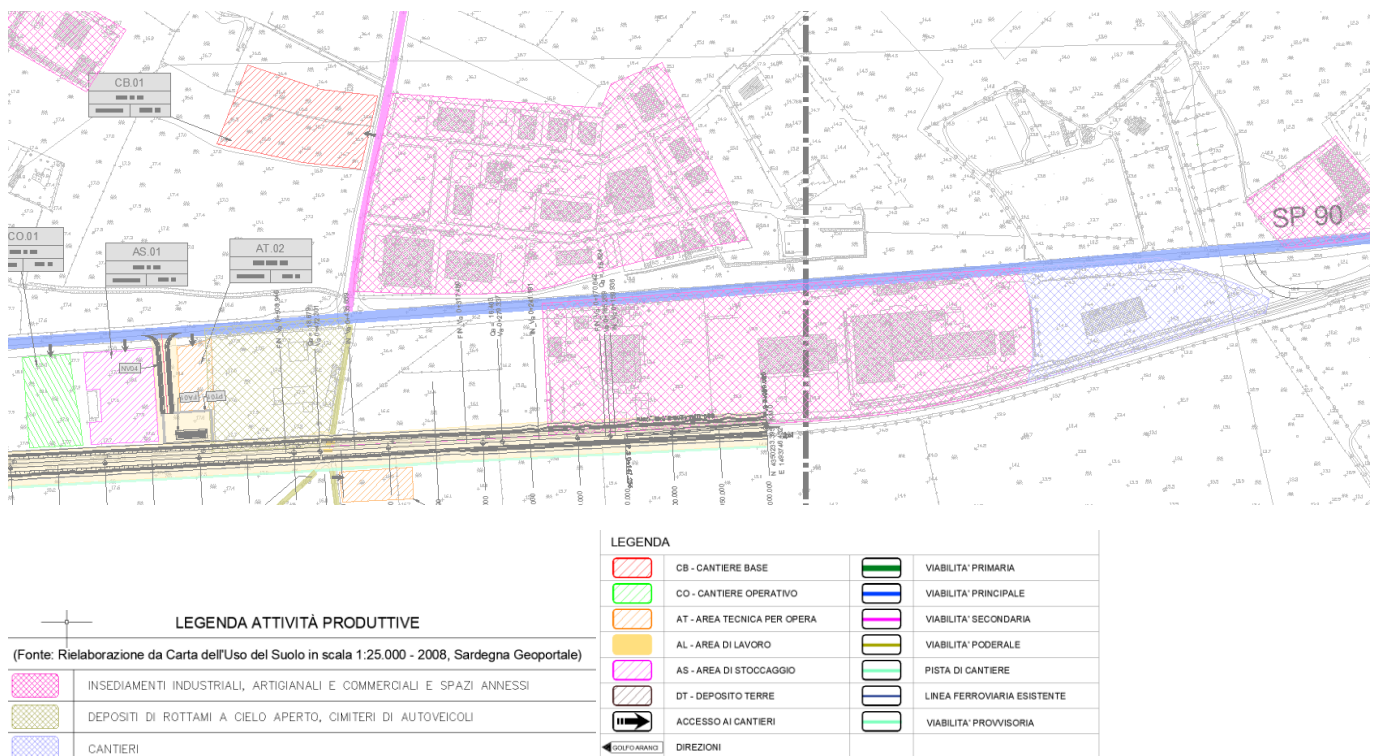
Ubicazione attività produttive rispetto alle aree di intervento
